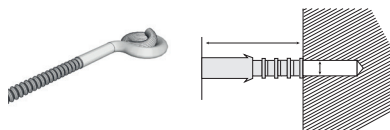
| Systèmes de fixations sur les façades (non exhaustifs)
